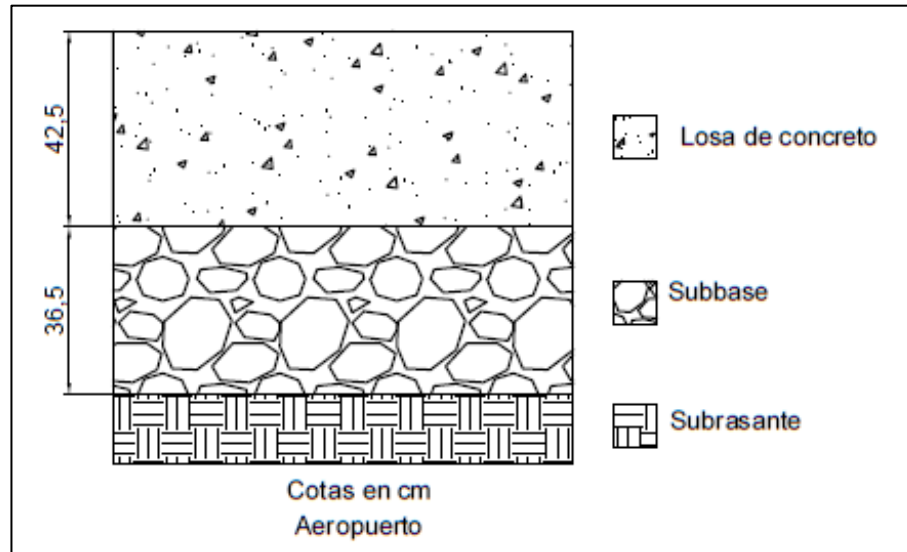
Estructura de pavimento en la puerta tres, AIJS
